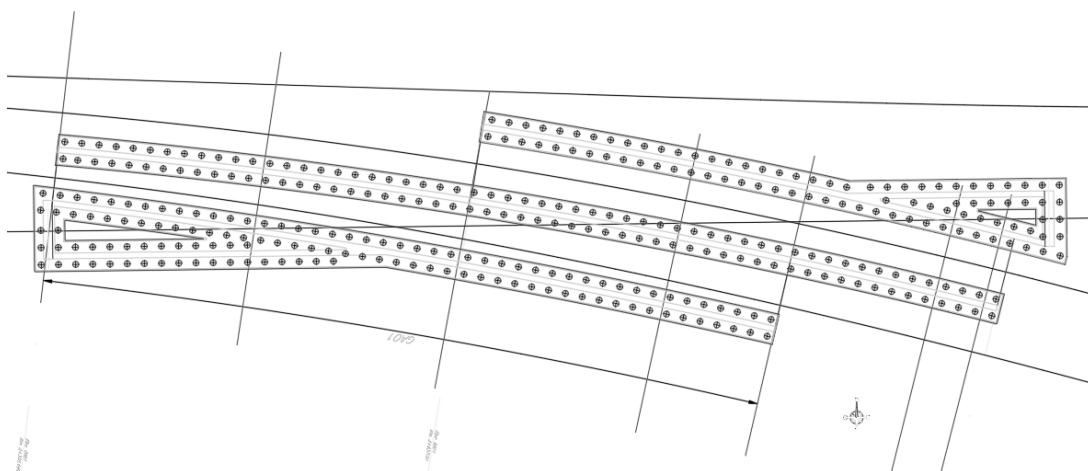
stralcio della carpenteria spalla e fondazione su n°17 pali affiancati
